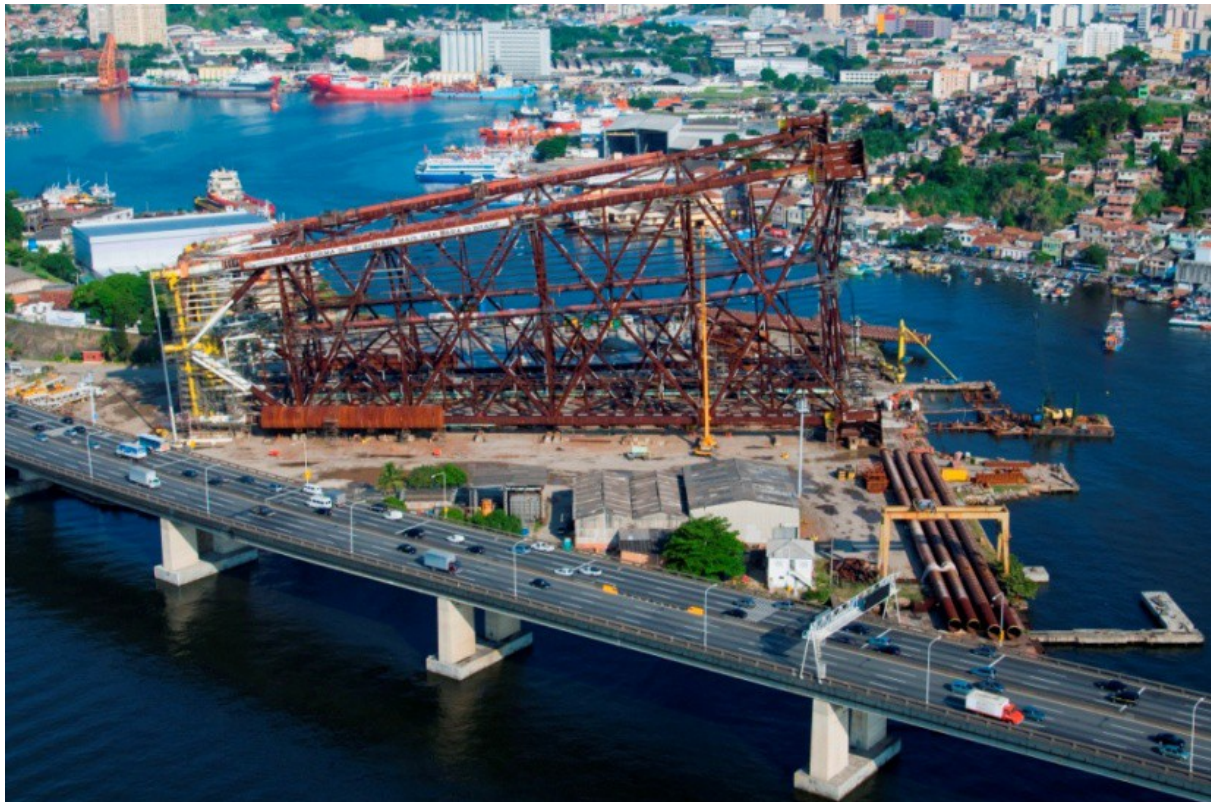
Jaqueta da Plataforma PMXL-1, em construção no canteiro na Ilha do Cajú do Estaleiro Mauá
